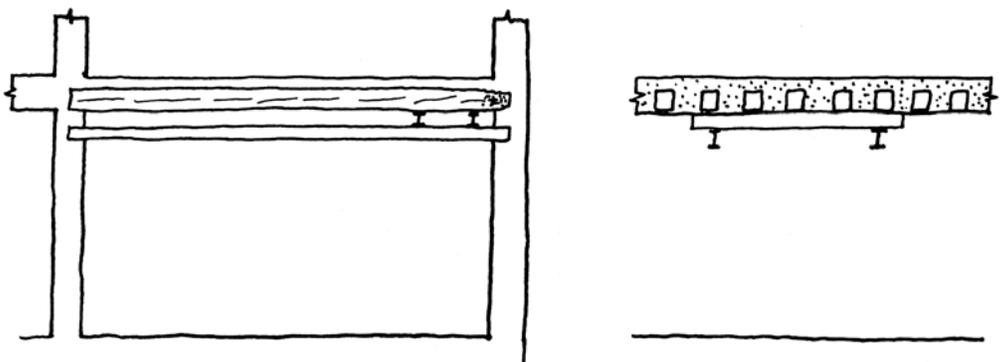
Reparaciones consistentes en alargar la longitud de la pieza o de apoyo sobre pieza exterior al muro
